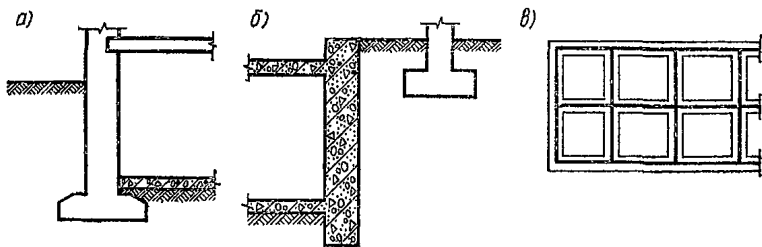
Конструктивные мероприятия, препятствующие смещению фундаментов
